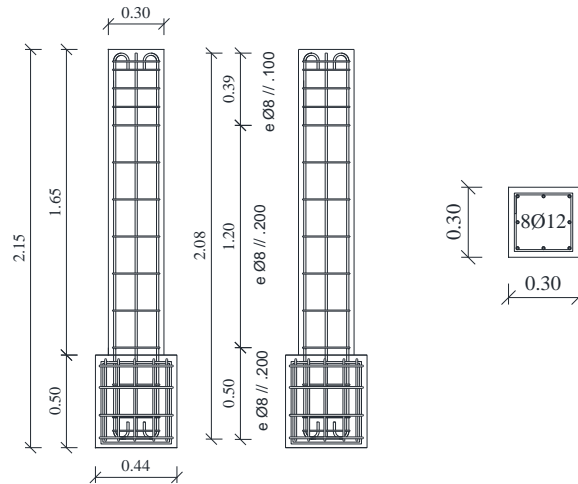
Dimensões e pormenorização das armaduras nos pilares com armadura lisa.
